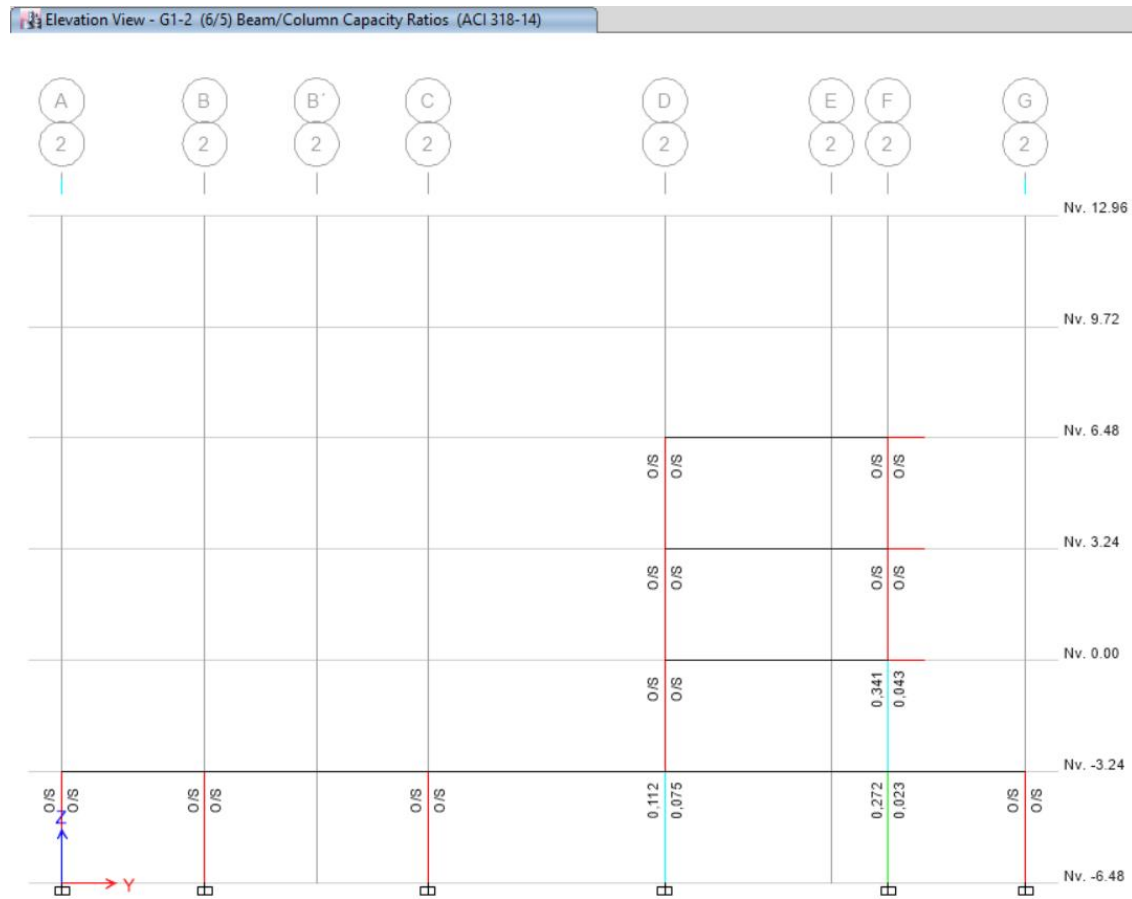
Vista en elevación de factor de capacidad unión viga-columnas, pórtico eje 1.
